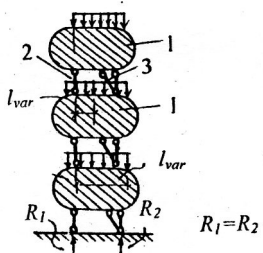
Схема к обоснованию равномерности распределения нагрузки от перекрытий на колонны
